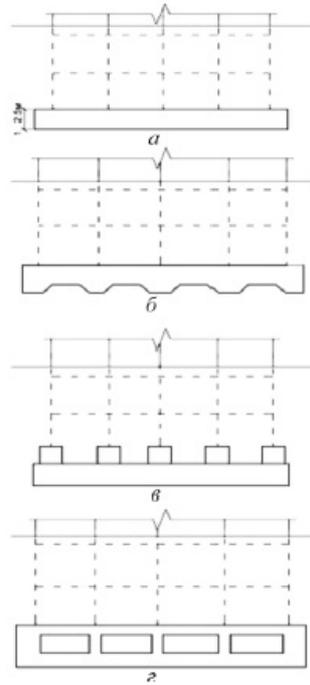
Различные конструкции монолитной сплошной плиты из железобетона
